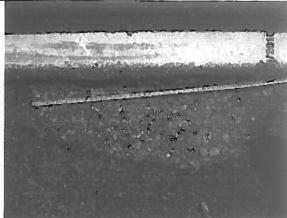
(25.03.2015) Grieta transversal km 13. Calzada, sentido oriente. ASFALTO
